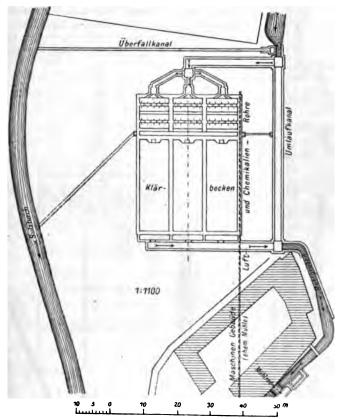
Situationsplan der Klärbeckenanlage in Wiesbaden.
